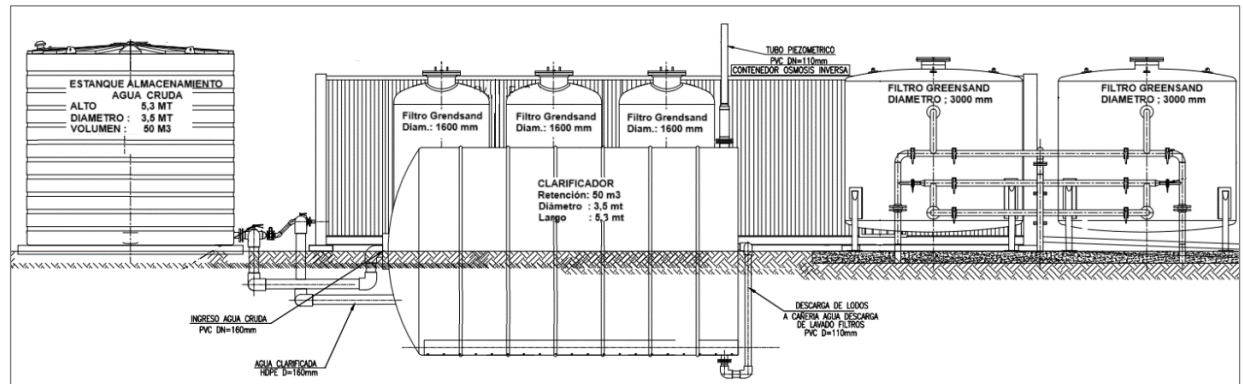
Diagrama pretratamiento planta potabilizadora
